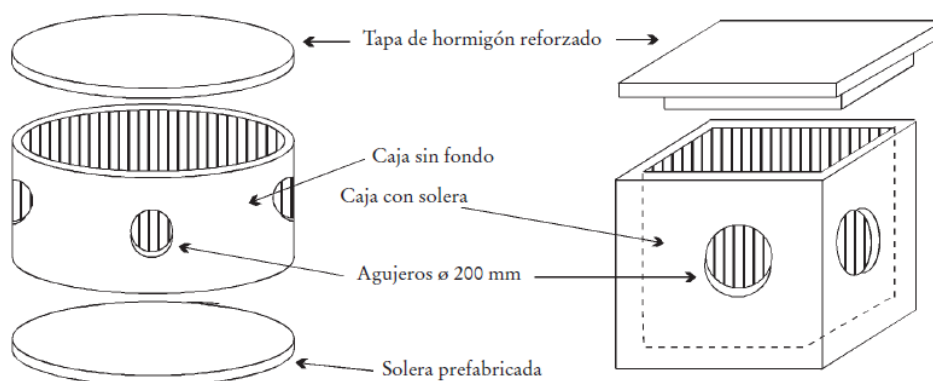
Tipos de Cajas de Unión (Fuente FAO)
